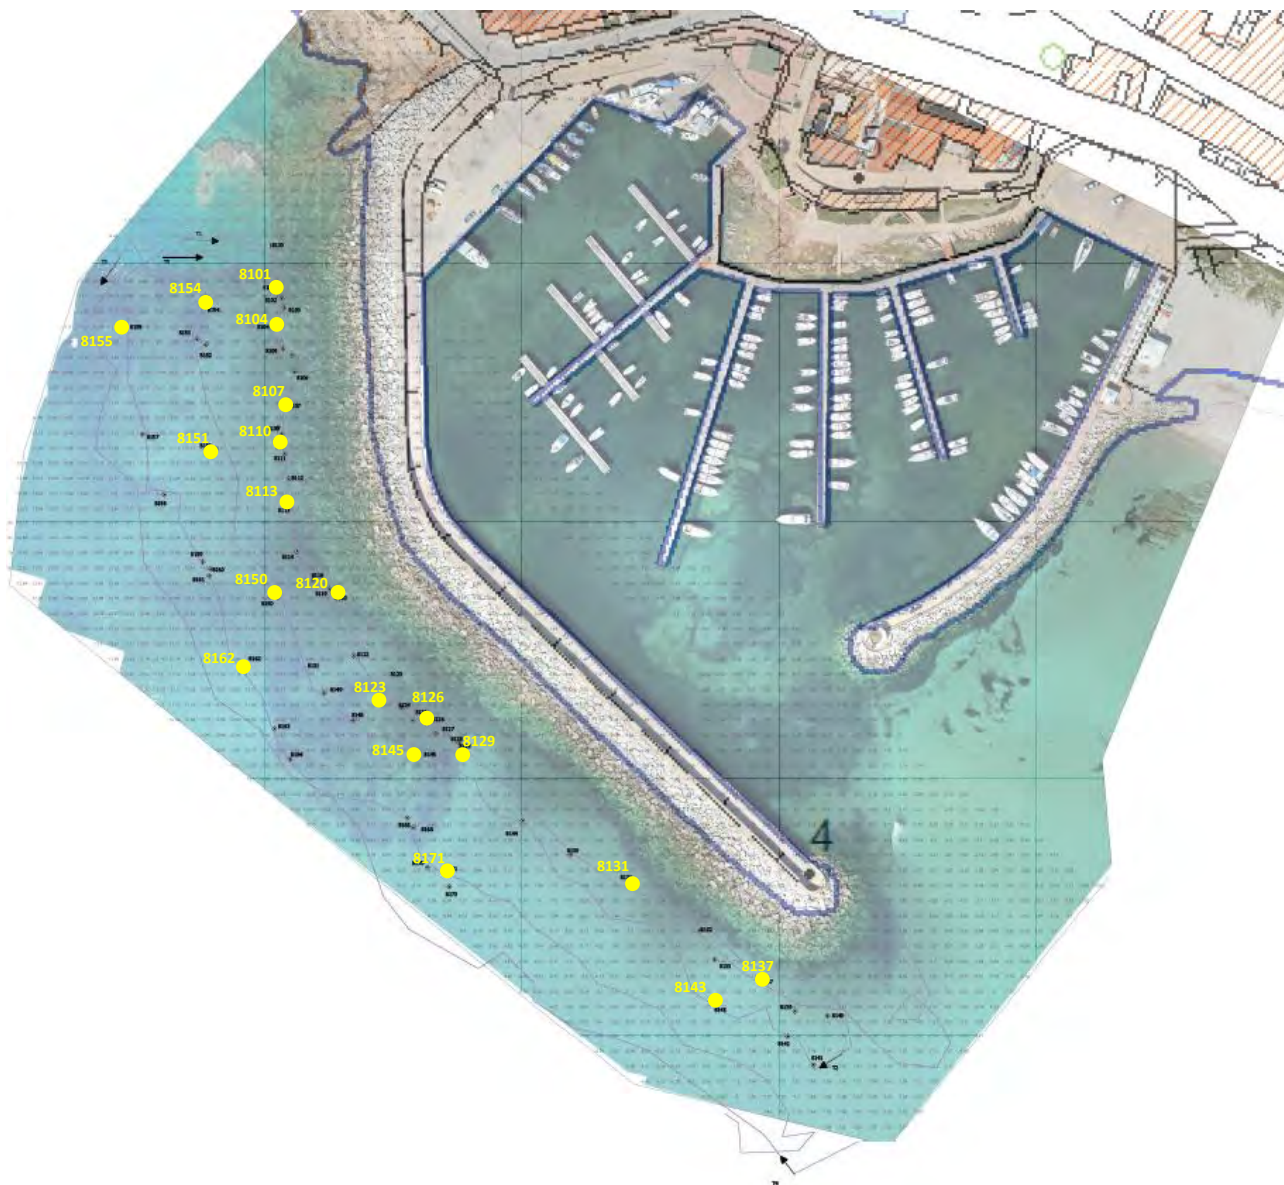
Planimetria con individuazione foto - ricognizione subacquea
